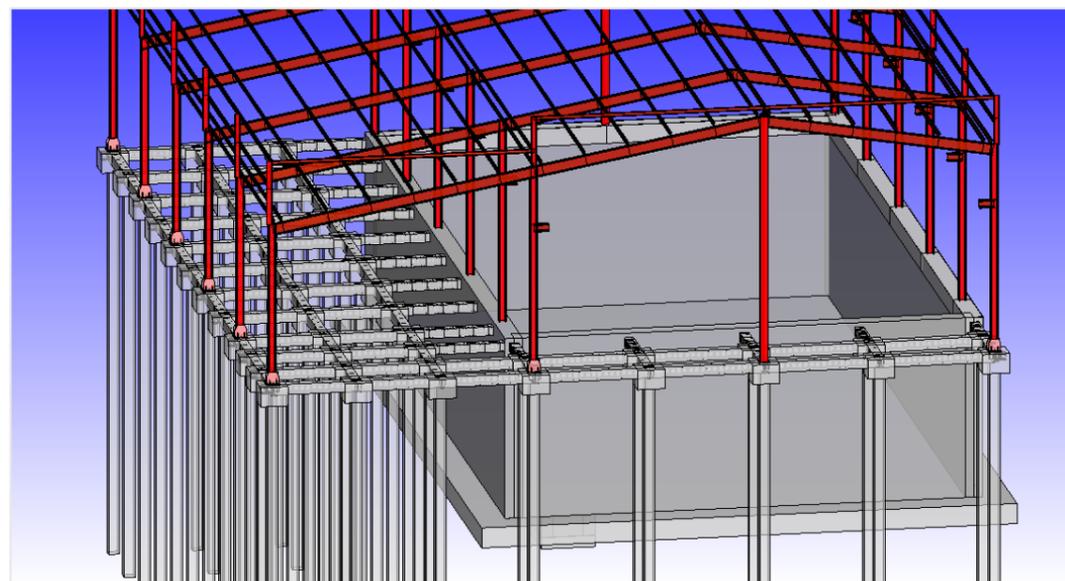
Encepado y pilotes de la estación de bombeo a riego. Cálculos estructurales
